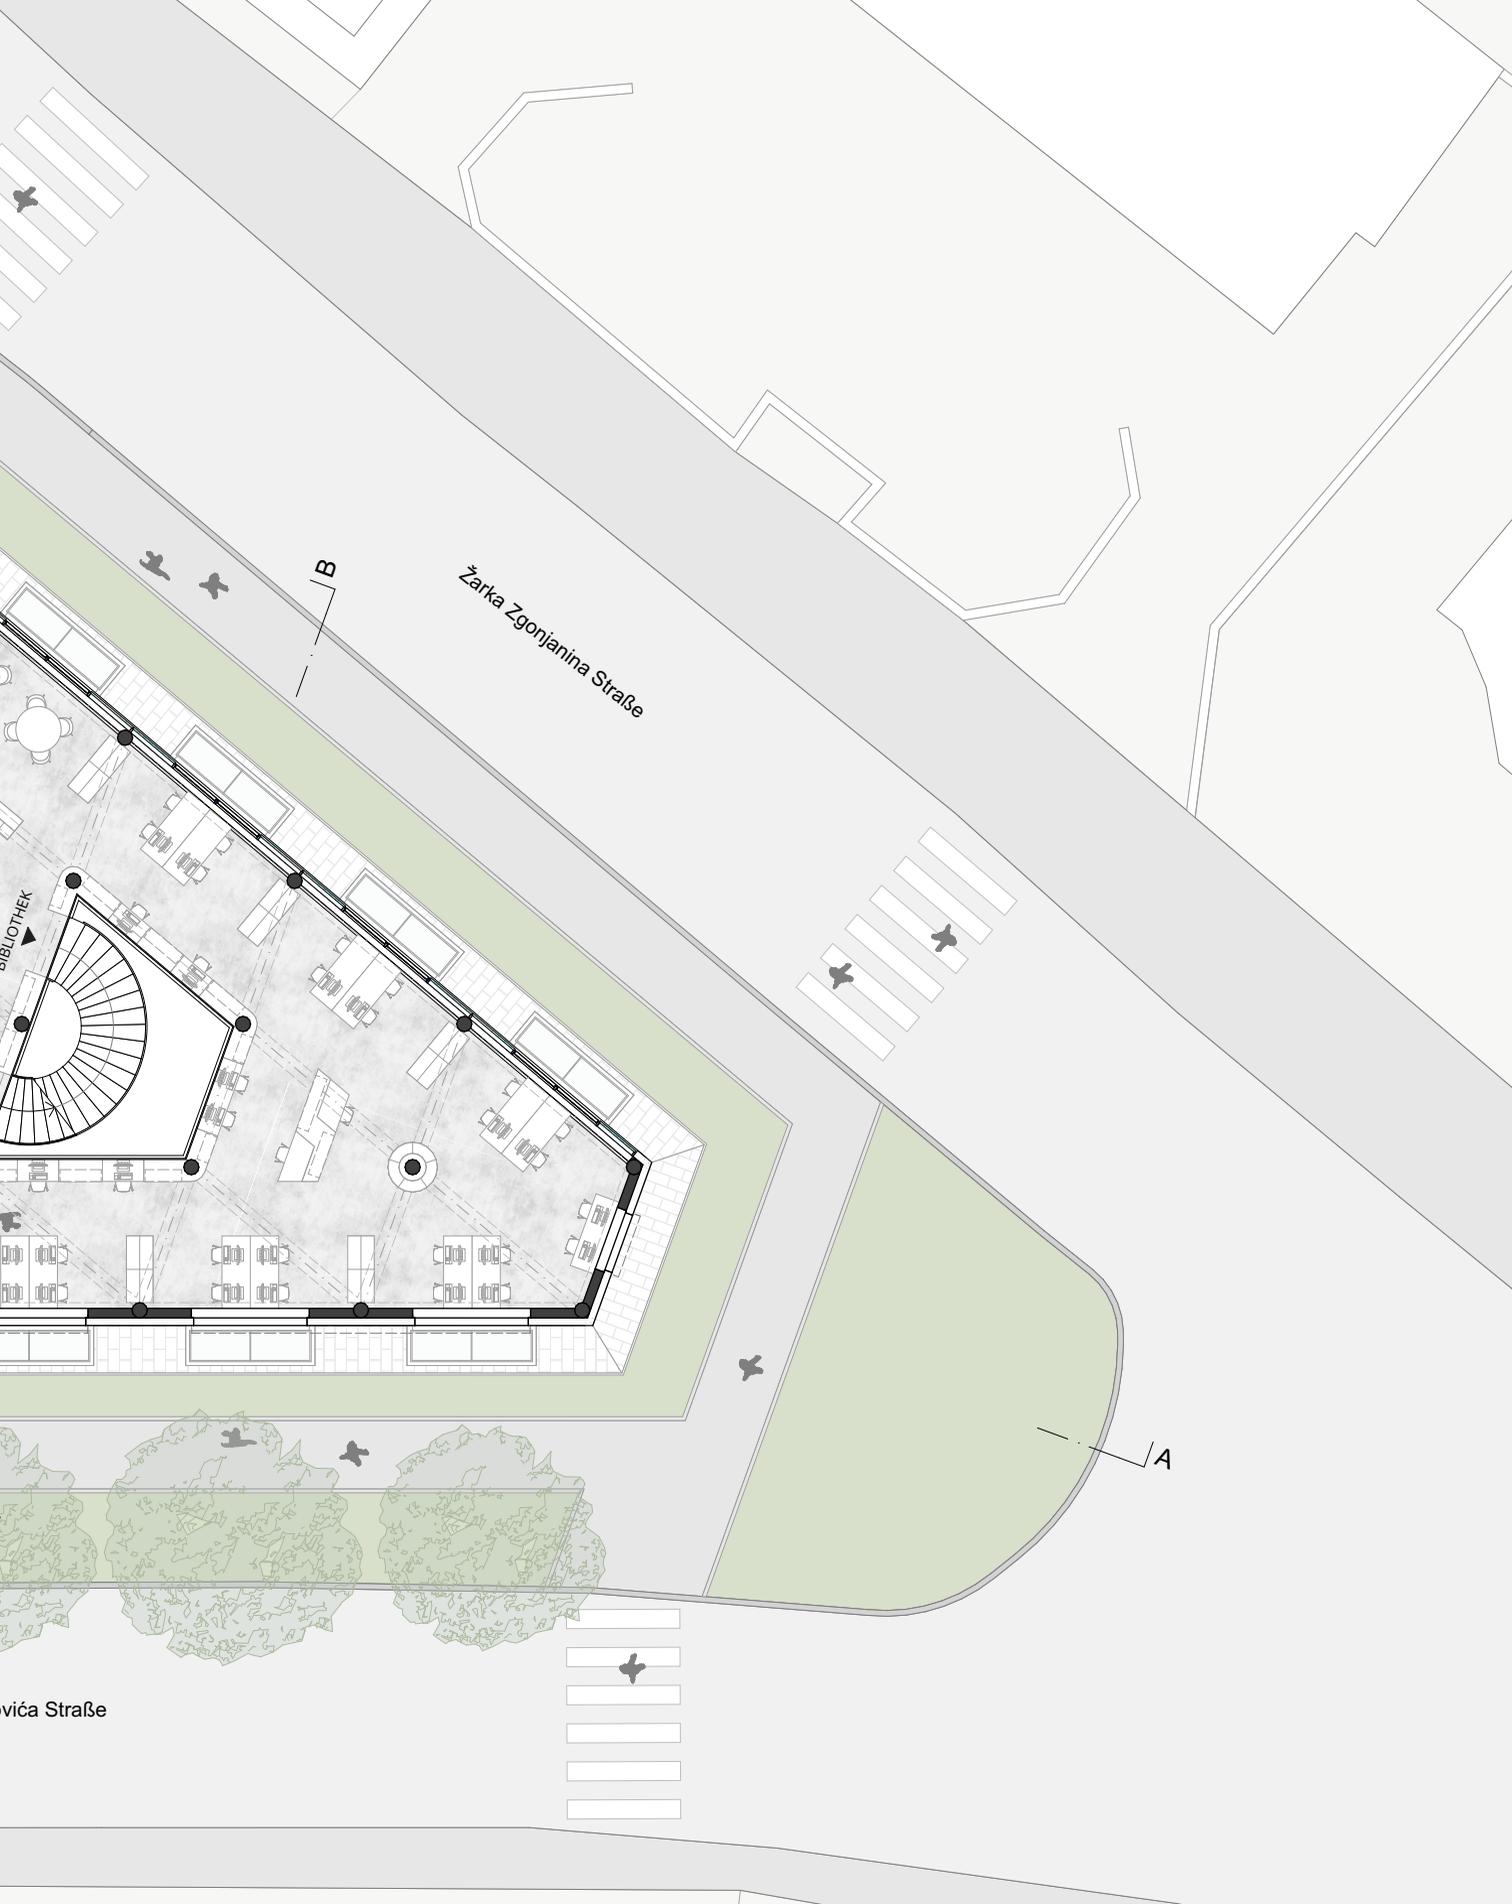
Grundriss Erdgeschoß mit der Umgebung M1: 200
